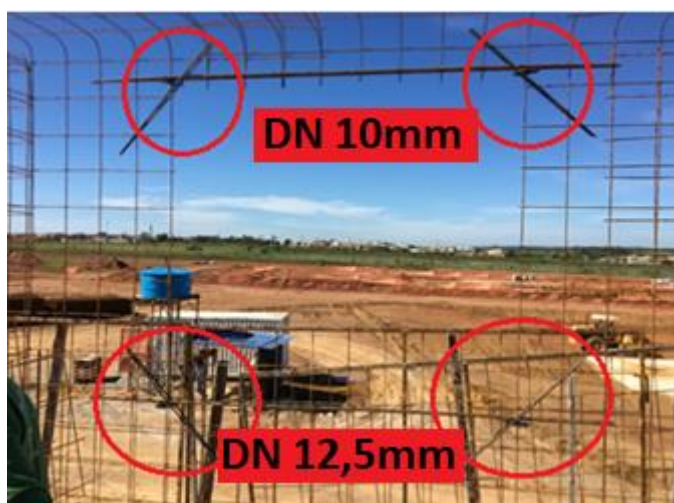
Instalação dos espaçadores de parede
